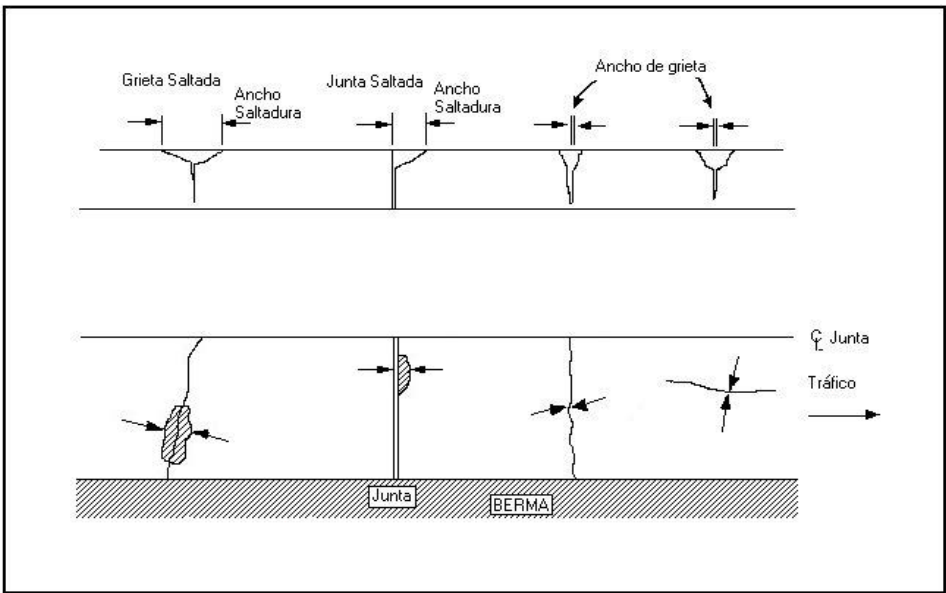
Medición de anchos de saltaduras en grietas y juntas de pavimentos de hormigón
